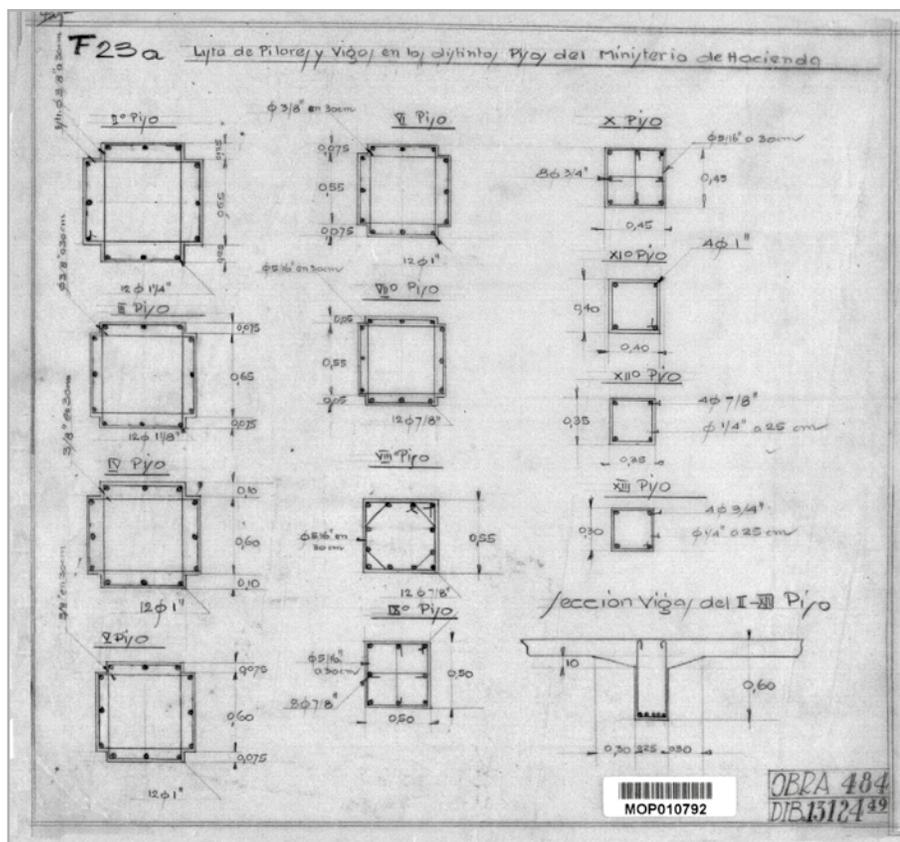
Plano de cálculo estructural, proyecto Ministerio de Hacienda. Detalle secciones pilares y vigas, s/f. Fuente: Archivo Digital Ministerio de Obras Públicas.
